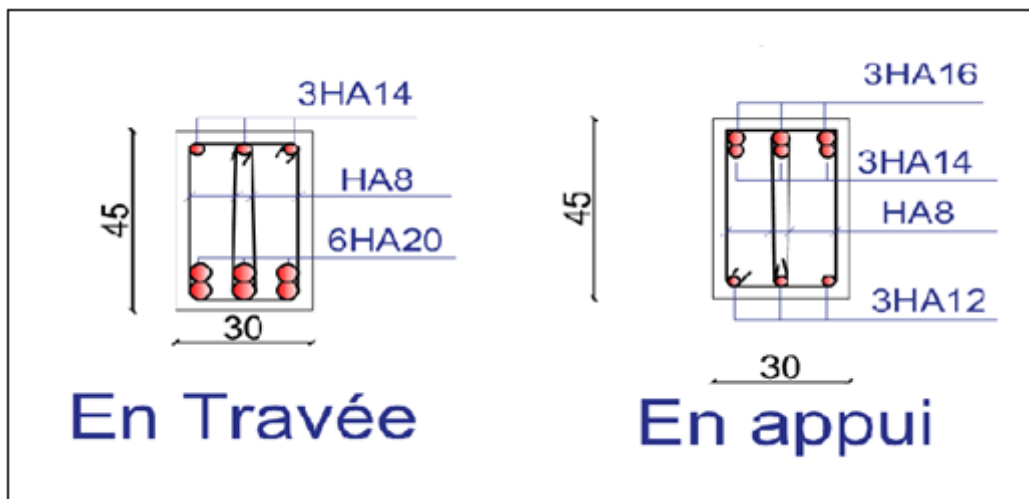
schéma de ferrailage des poutres principales liée au voile
